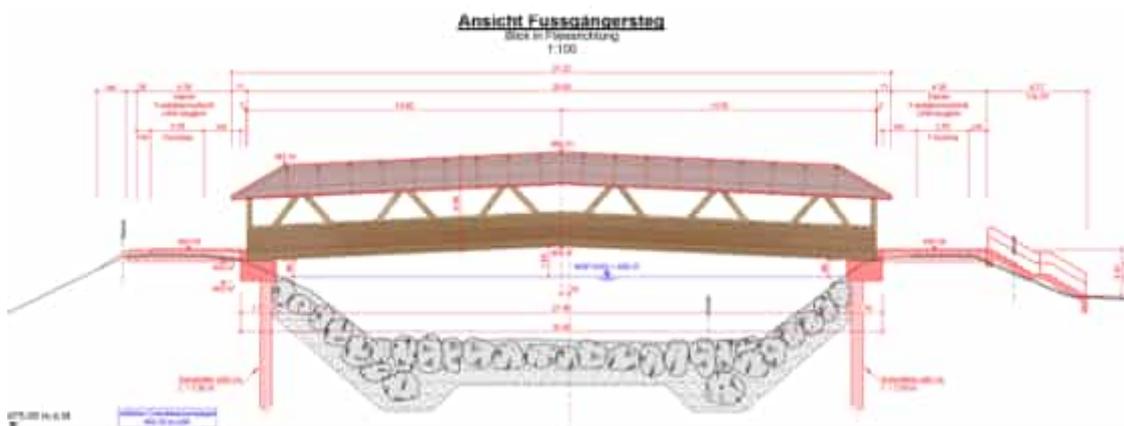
Ansicht Fussgängerbrücke Burersteg (GW-Spiegel auf 464.40 m; aus Plan 2287-536b Schubiger 2024)
